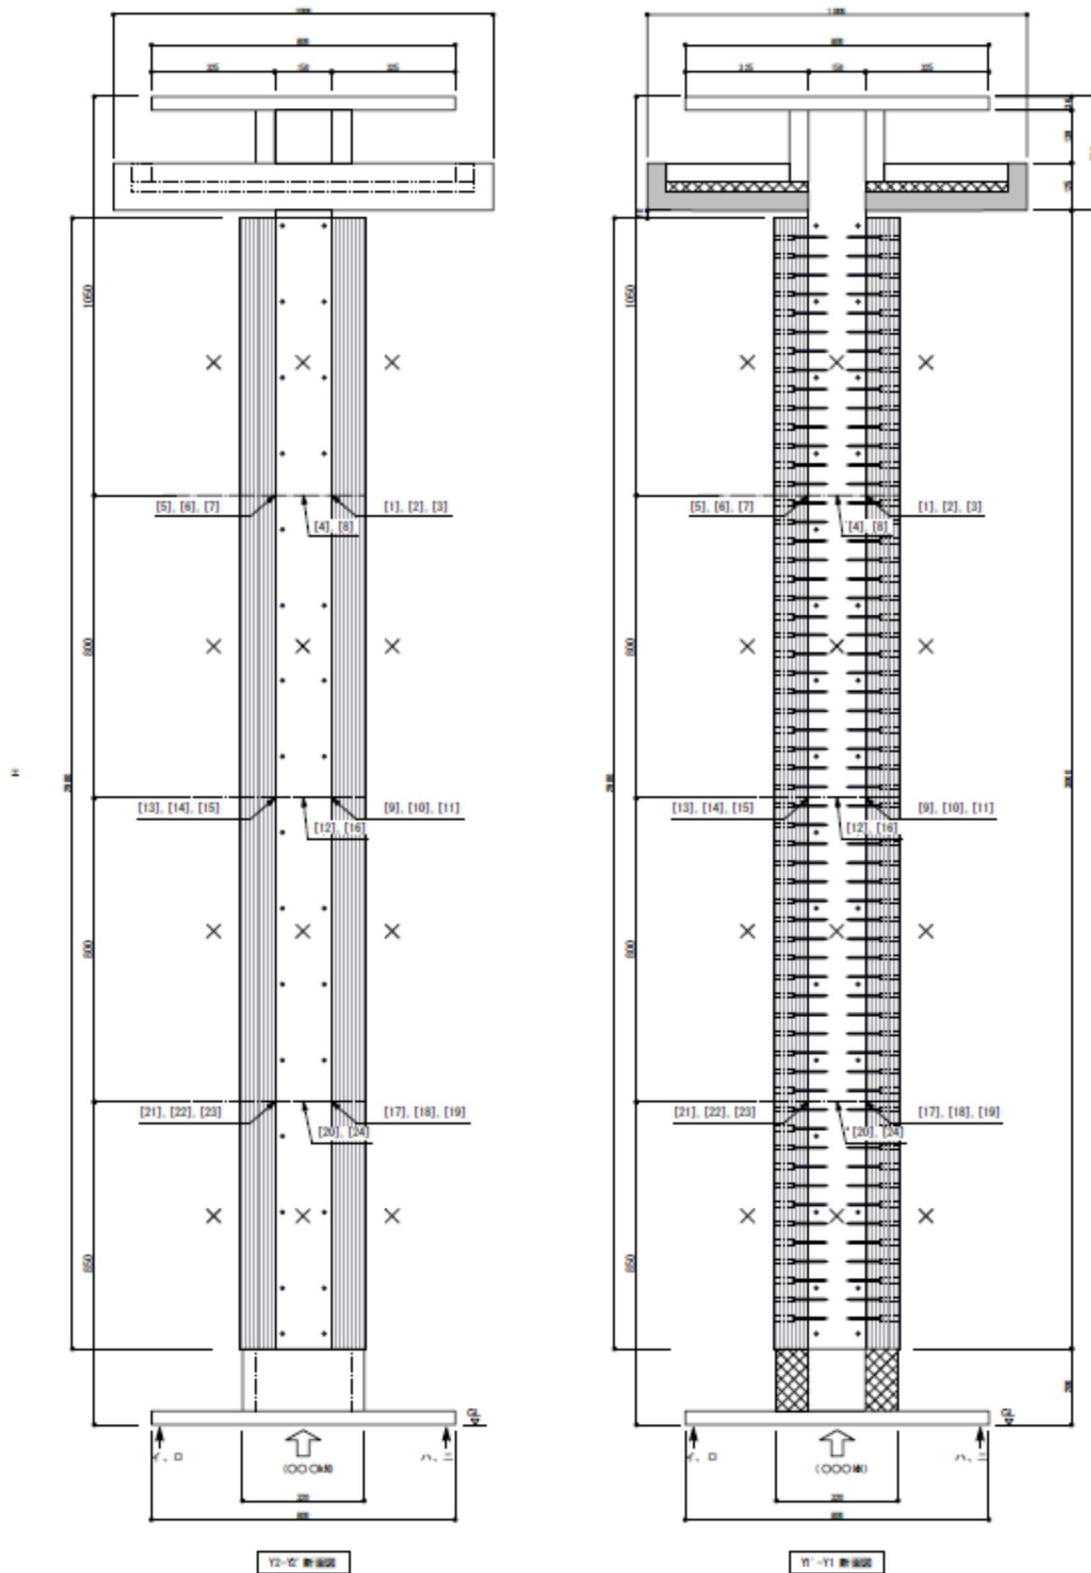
試験体の構造・寸法・温度測定位置 (Y 通り)
